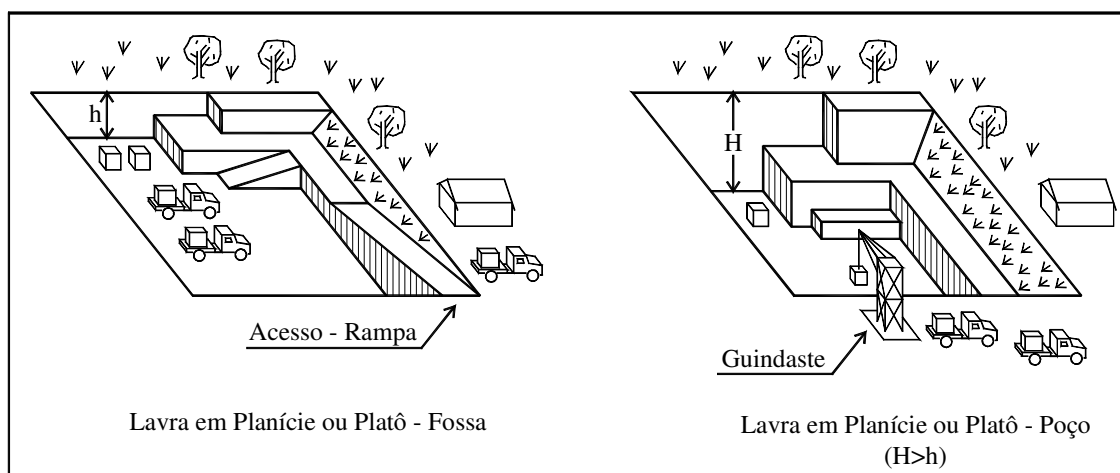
Terreno em planície ou platô – Lavra em fossa ou em poço.
